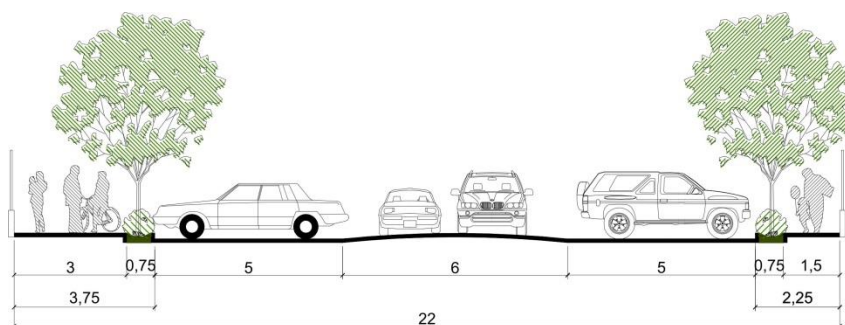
Perfil da VIA LOCAL – 2 faixas estacionamento.
